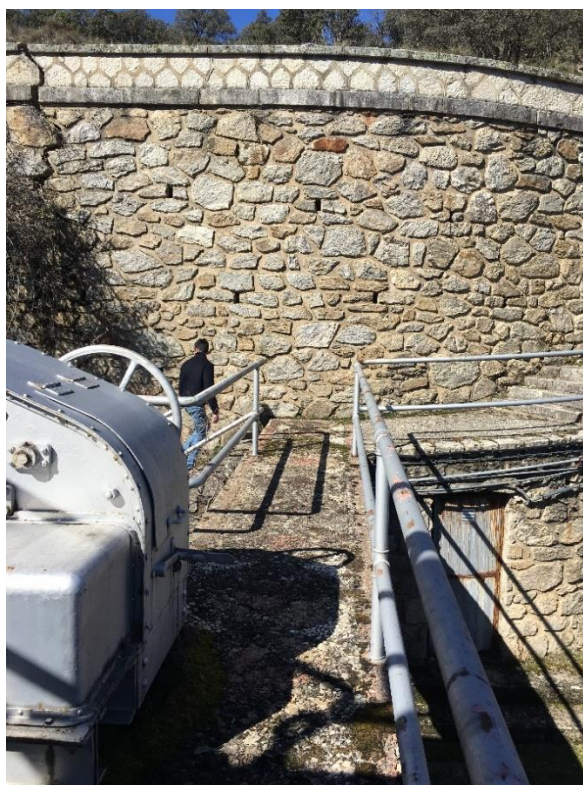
Fotografía del extradós del muro en zona de la grieta 2.
